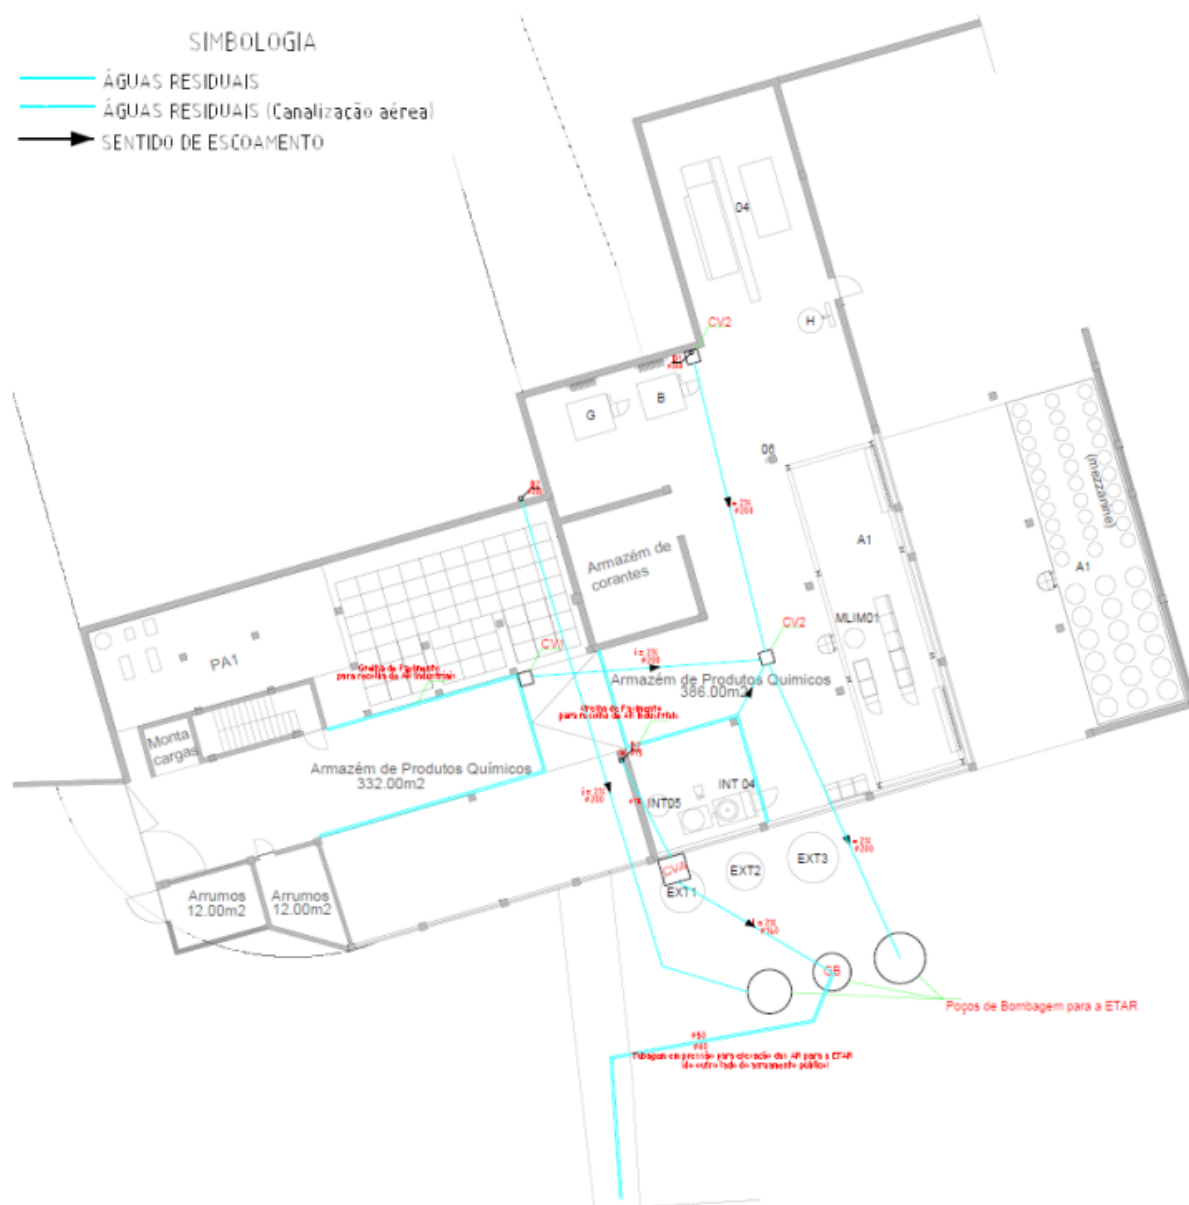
Planta da rede de drenagem de águas residuais industriais da cave Projeto
